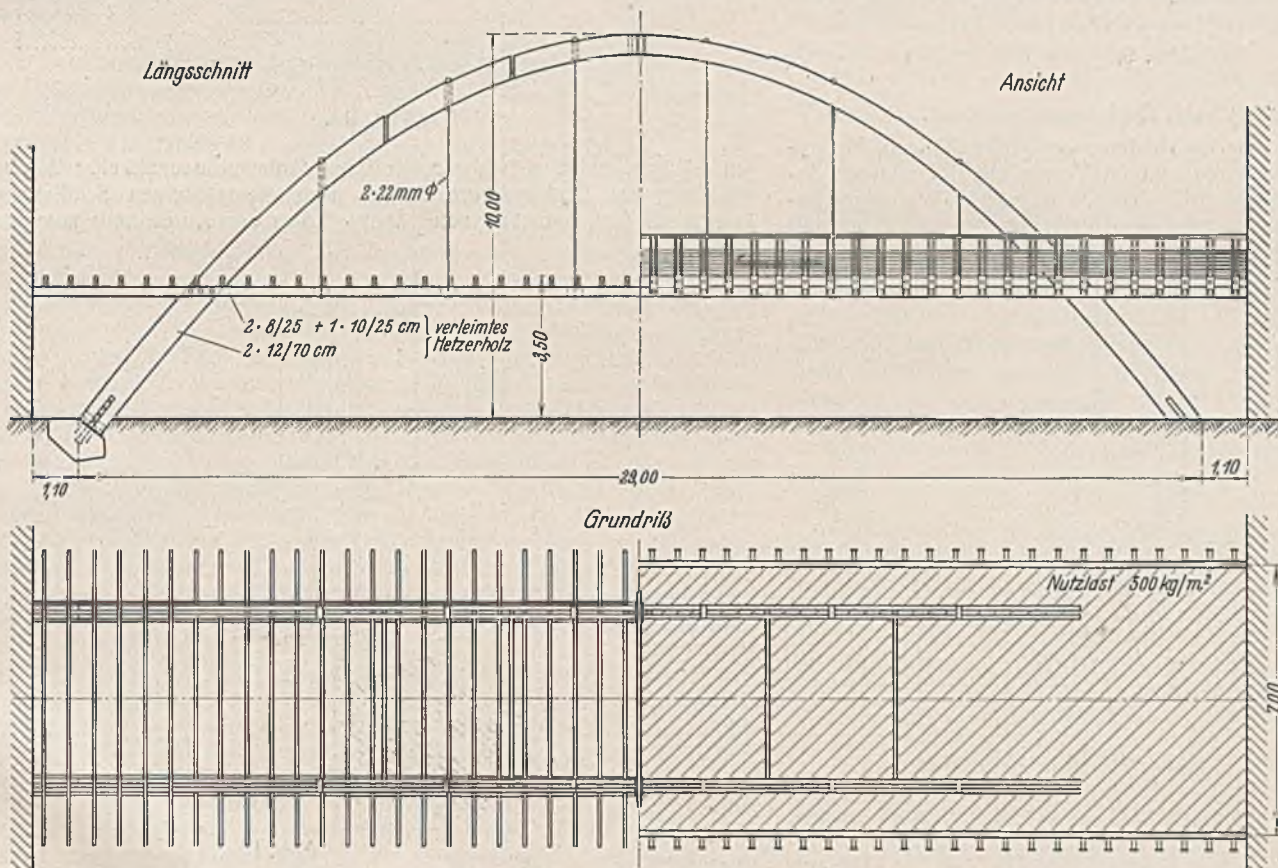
Brücke in Hetzer-Bauweise. Längsschnitt, Ansicht und Grundriß.
